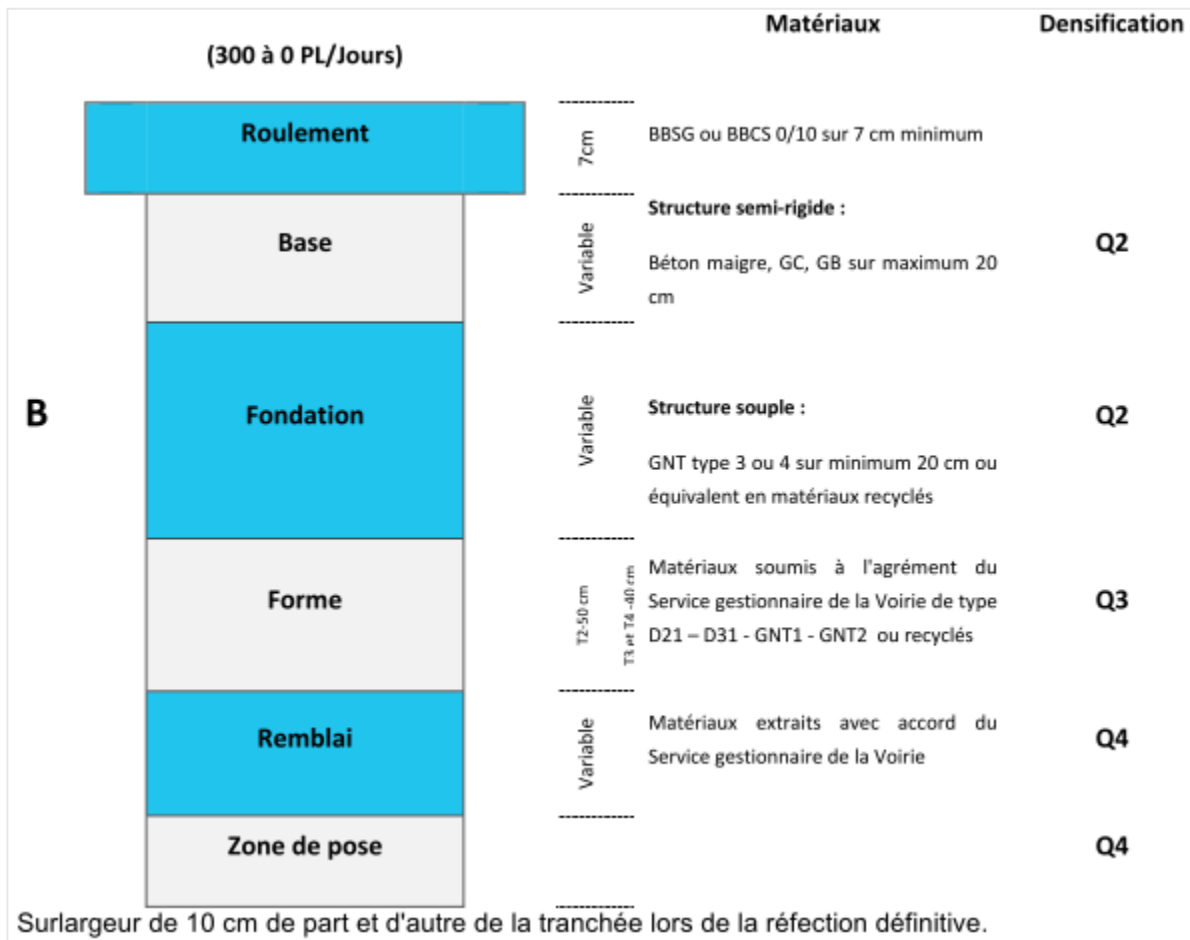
Structure de chaussée type - Extrait du Règlement de Voirie
